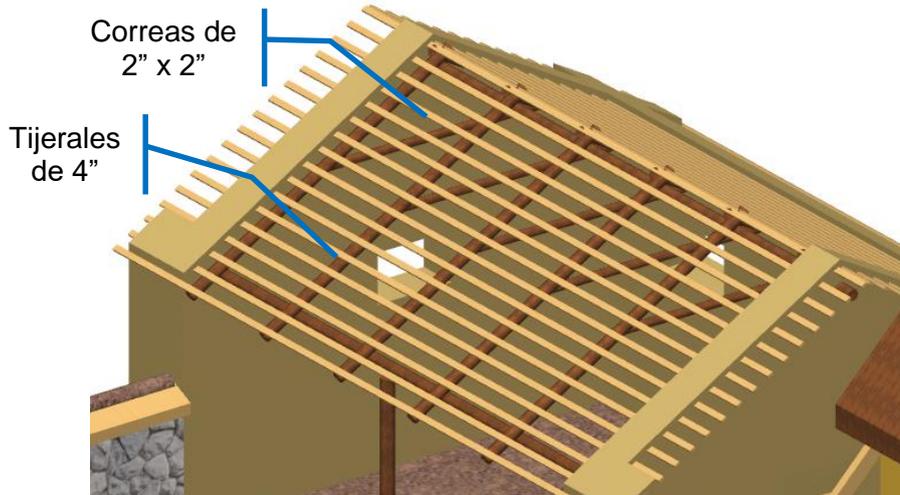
Detalle de correas y tijeral en techo de cobertizo.
